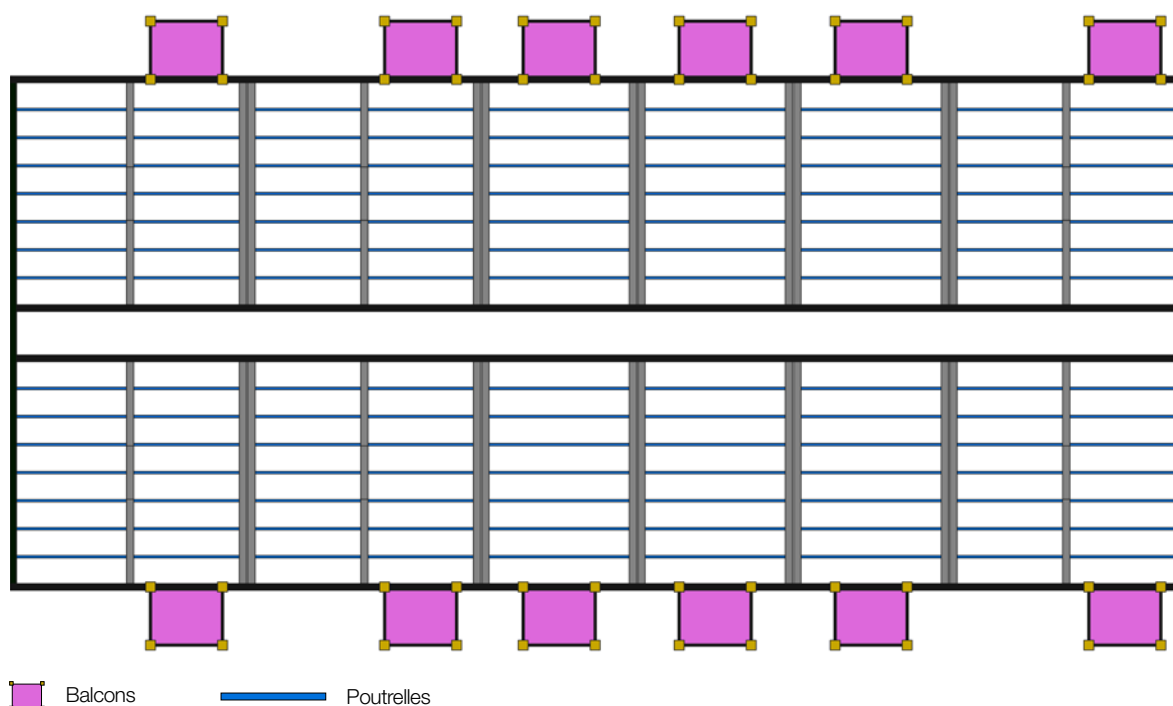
• Balcon sur mur parallèle aux poutrelles
